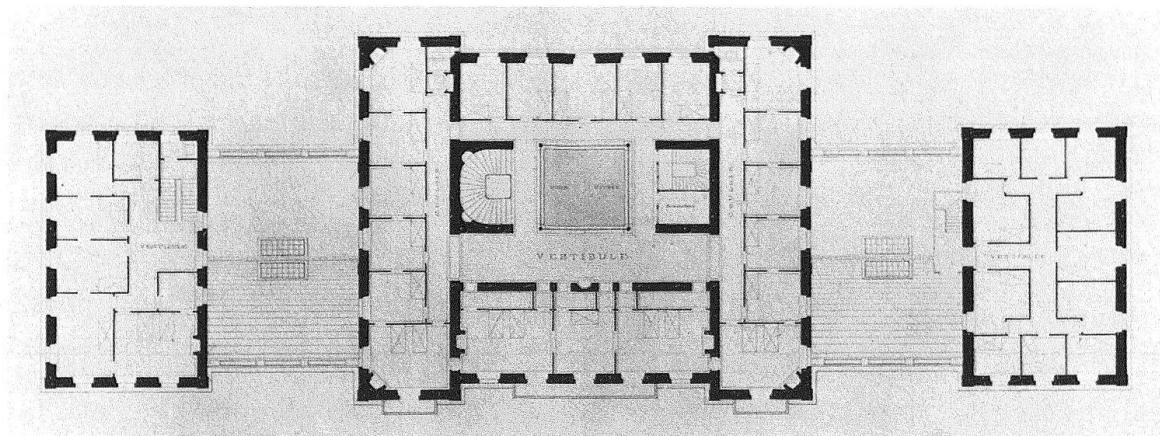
Morges. Hôtel du Mont Blanc, plan du premier étage
